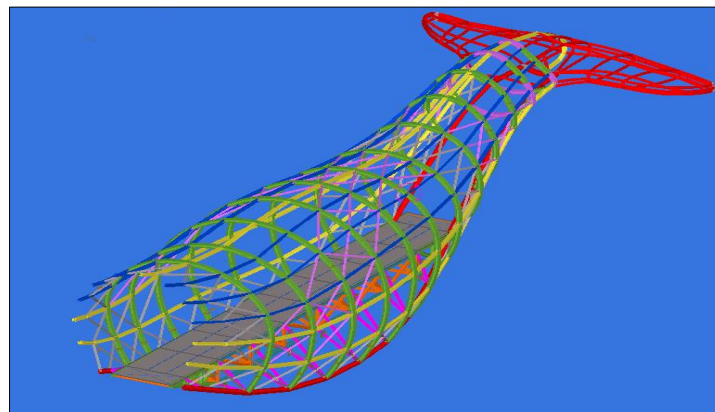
Modelação Tridimensional em Tekla da Estrutura Metálica do Passadiço com revestimento em formato de Baleia.
